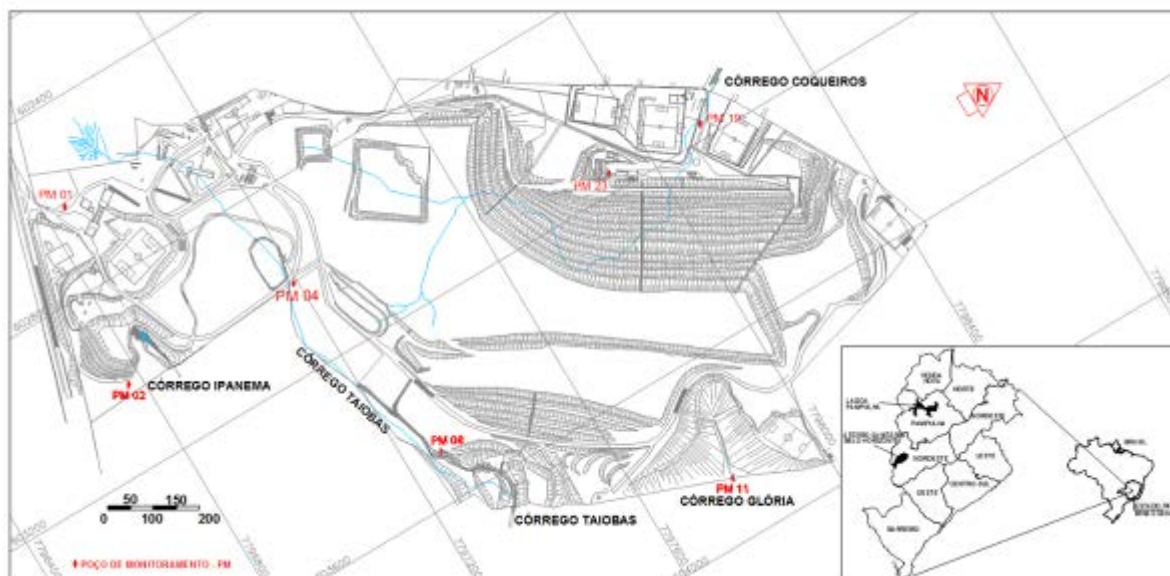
Aterro Sanitário de Belo Horizonte, MG
